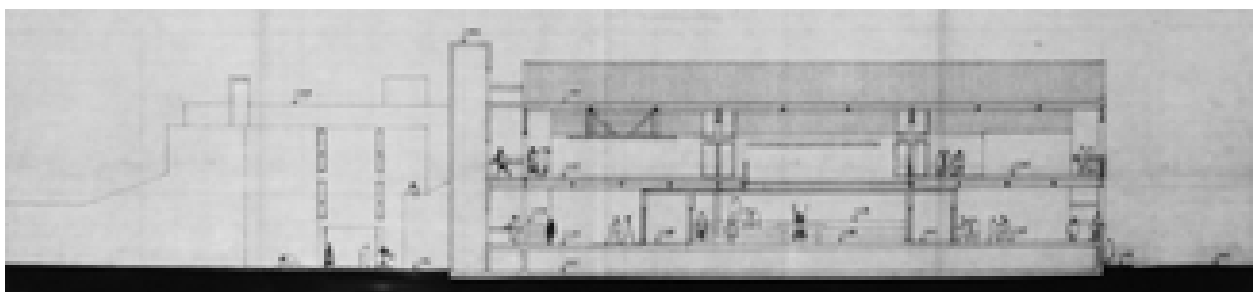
Sezione DD, stato attuale –09/12/1997 (AABS-1996.510)
